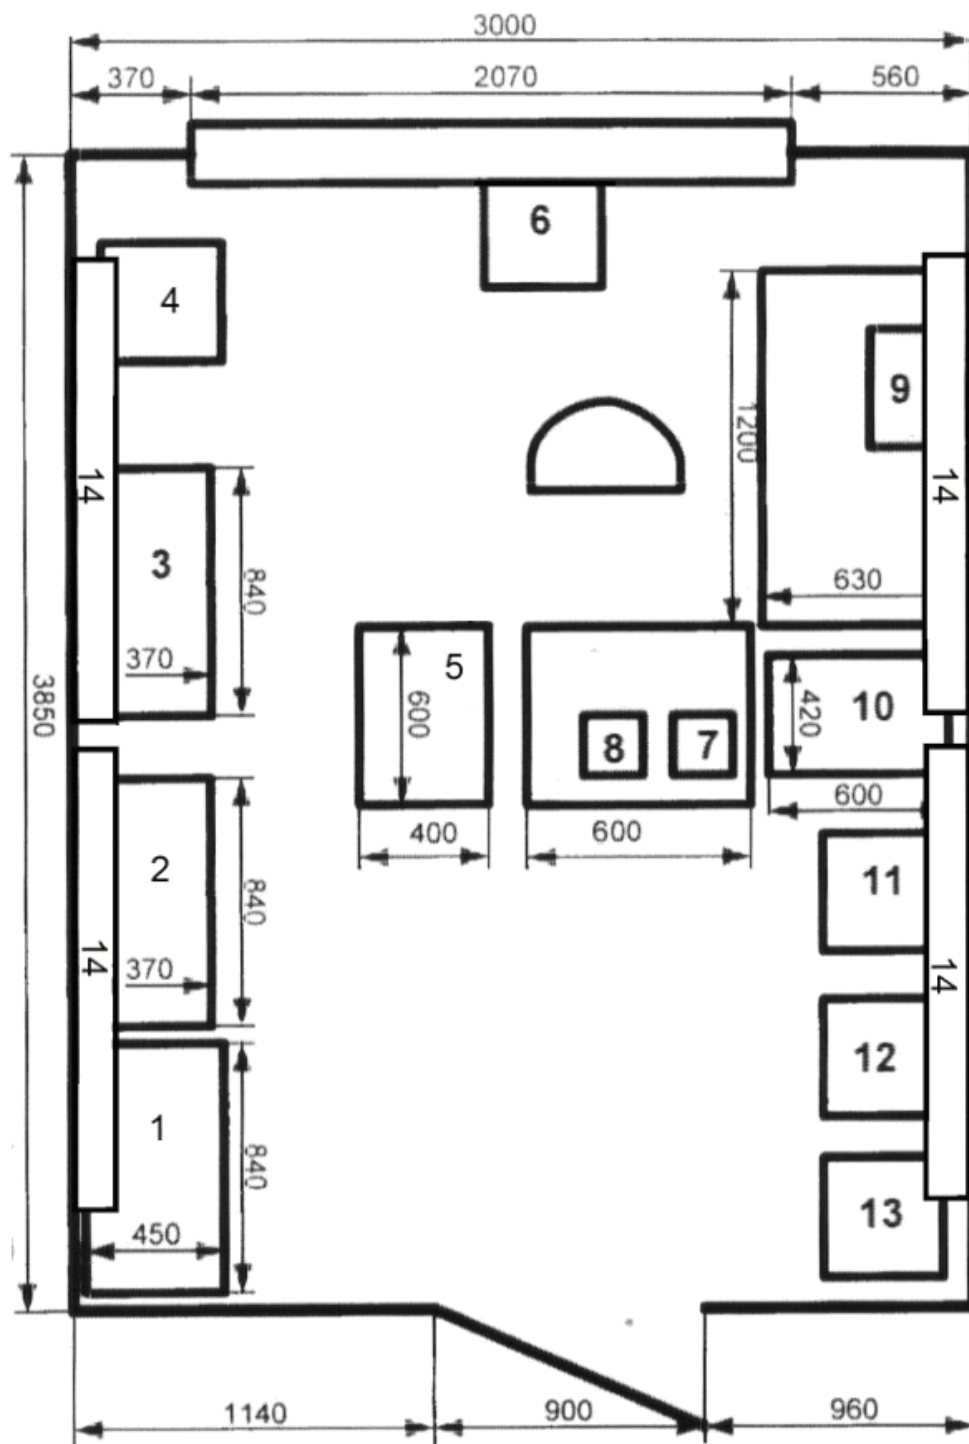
Схема планировки цеха сварки и пайки
